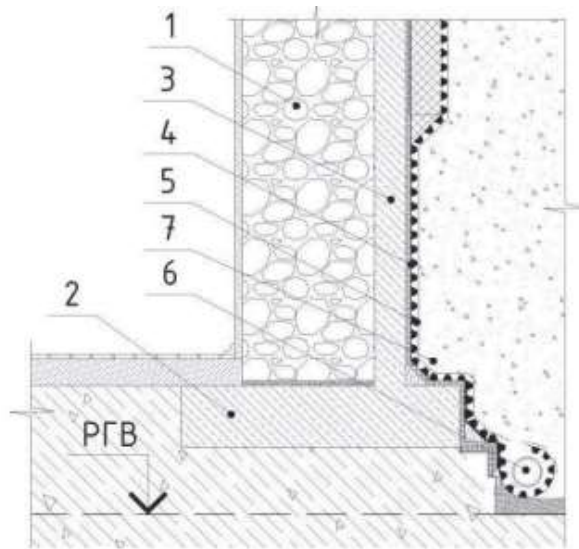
Схема підсилення фундаментів за допомогою збільшення опорної площі та односторонніх бенкетів: 1 – існуючий фундамент; 2 – монолітна залізобетонна плита; 3 – залізобетонна стінка (бенкет); 4 – шиповидна гідро ізолююча мембрана; 5 – геотекстиль; 6 – дренажна труба; 7 – грунт зворотньої засипки.
